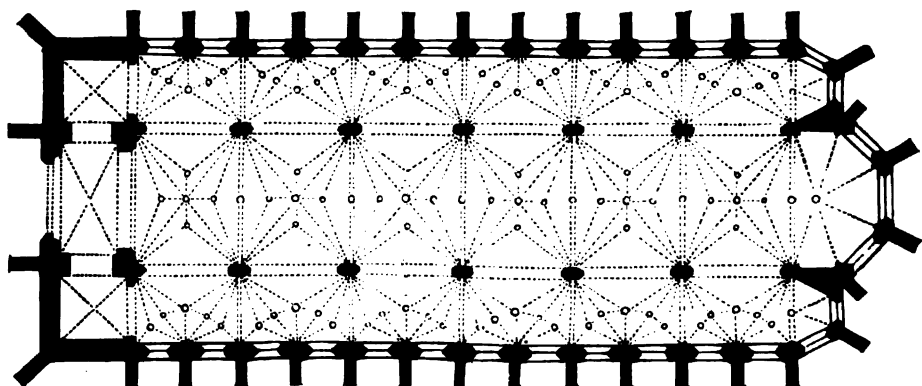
Grundriss der Sandkirche zu Breslau
